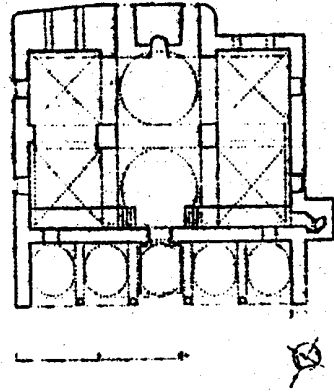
مسقط أفقي لجامع أحمد كـتـخـذا العزب بقلعة القاهرة .
